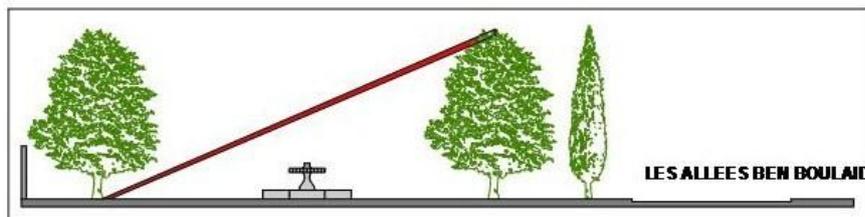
Coupe qui montre le rapport entre la largeur de la place et la hauteur des arbres.
